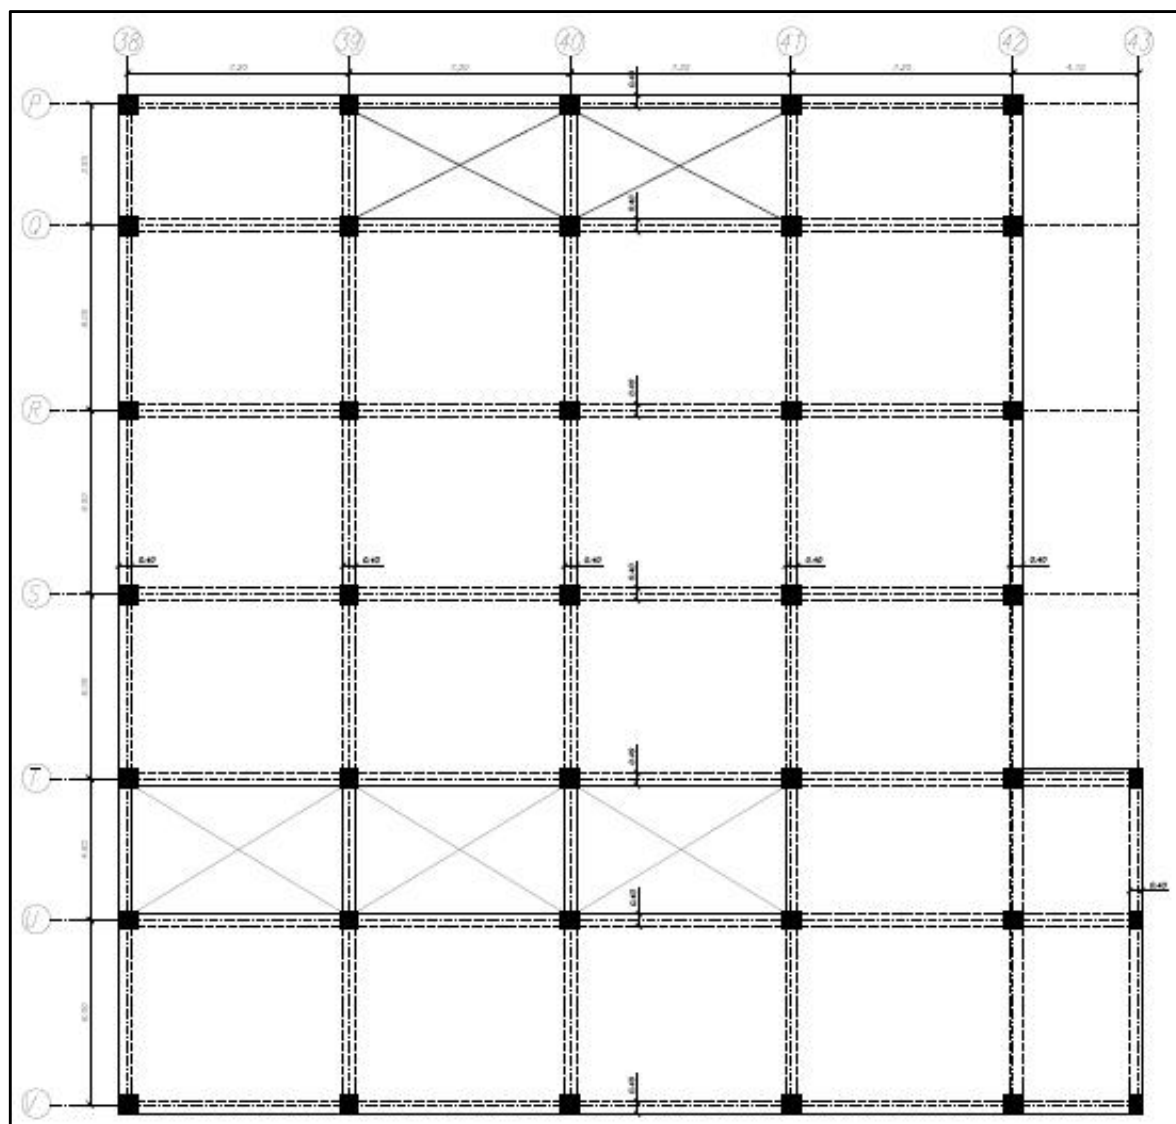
Planta estructural N+7.92, Consulta Externa I
